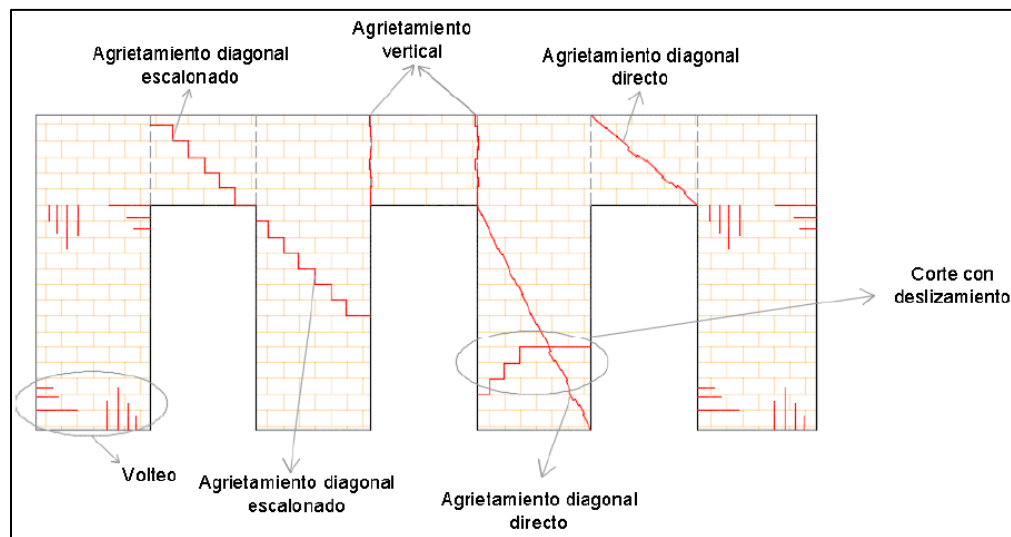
Modos de falla en pilares y vigas dintel, fuente (Jiménez Pacheco, 2016)
